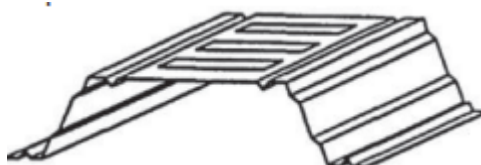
Профільований настил з поздовжніми та поперечними елементами жорсткості [129]
